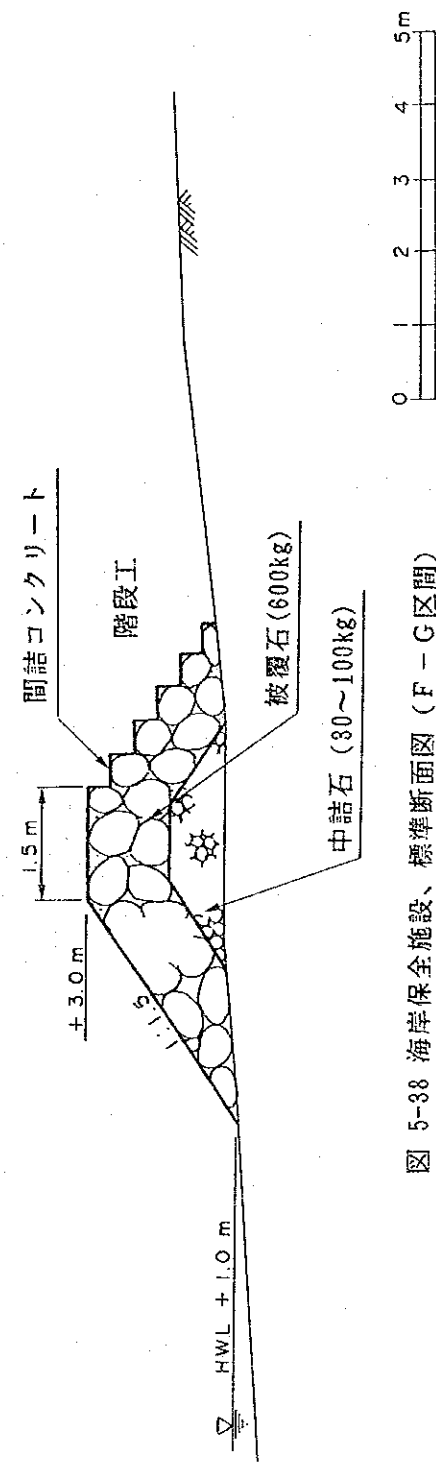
海岸保全施設、標準断面図 (F - G 区間)
